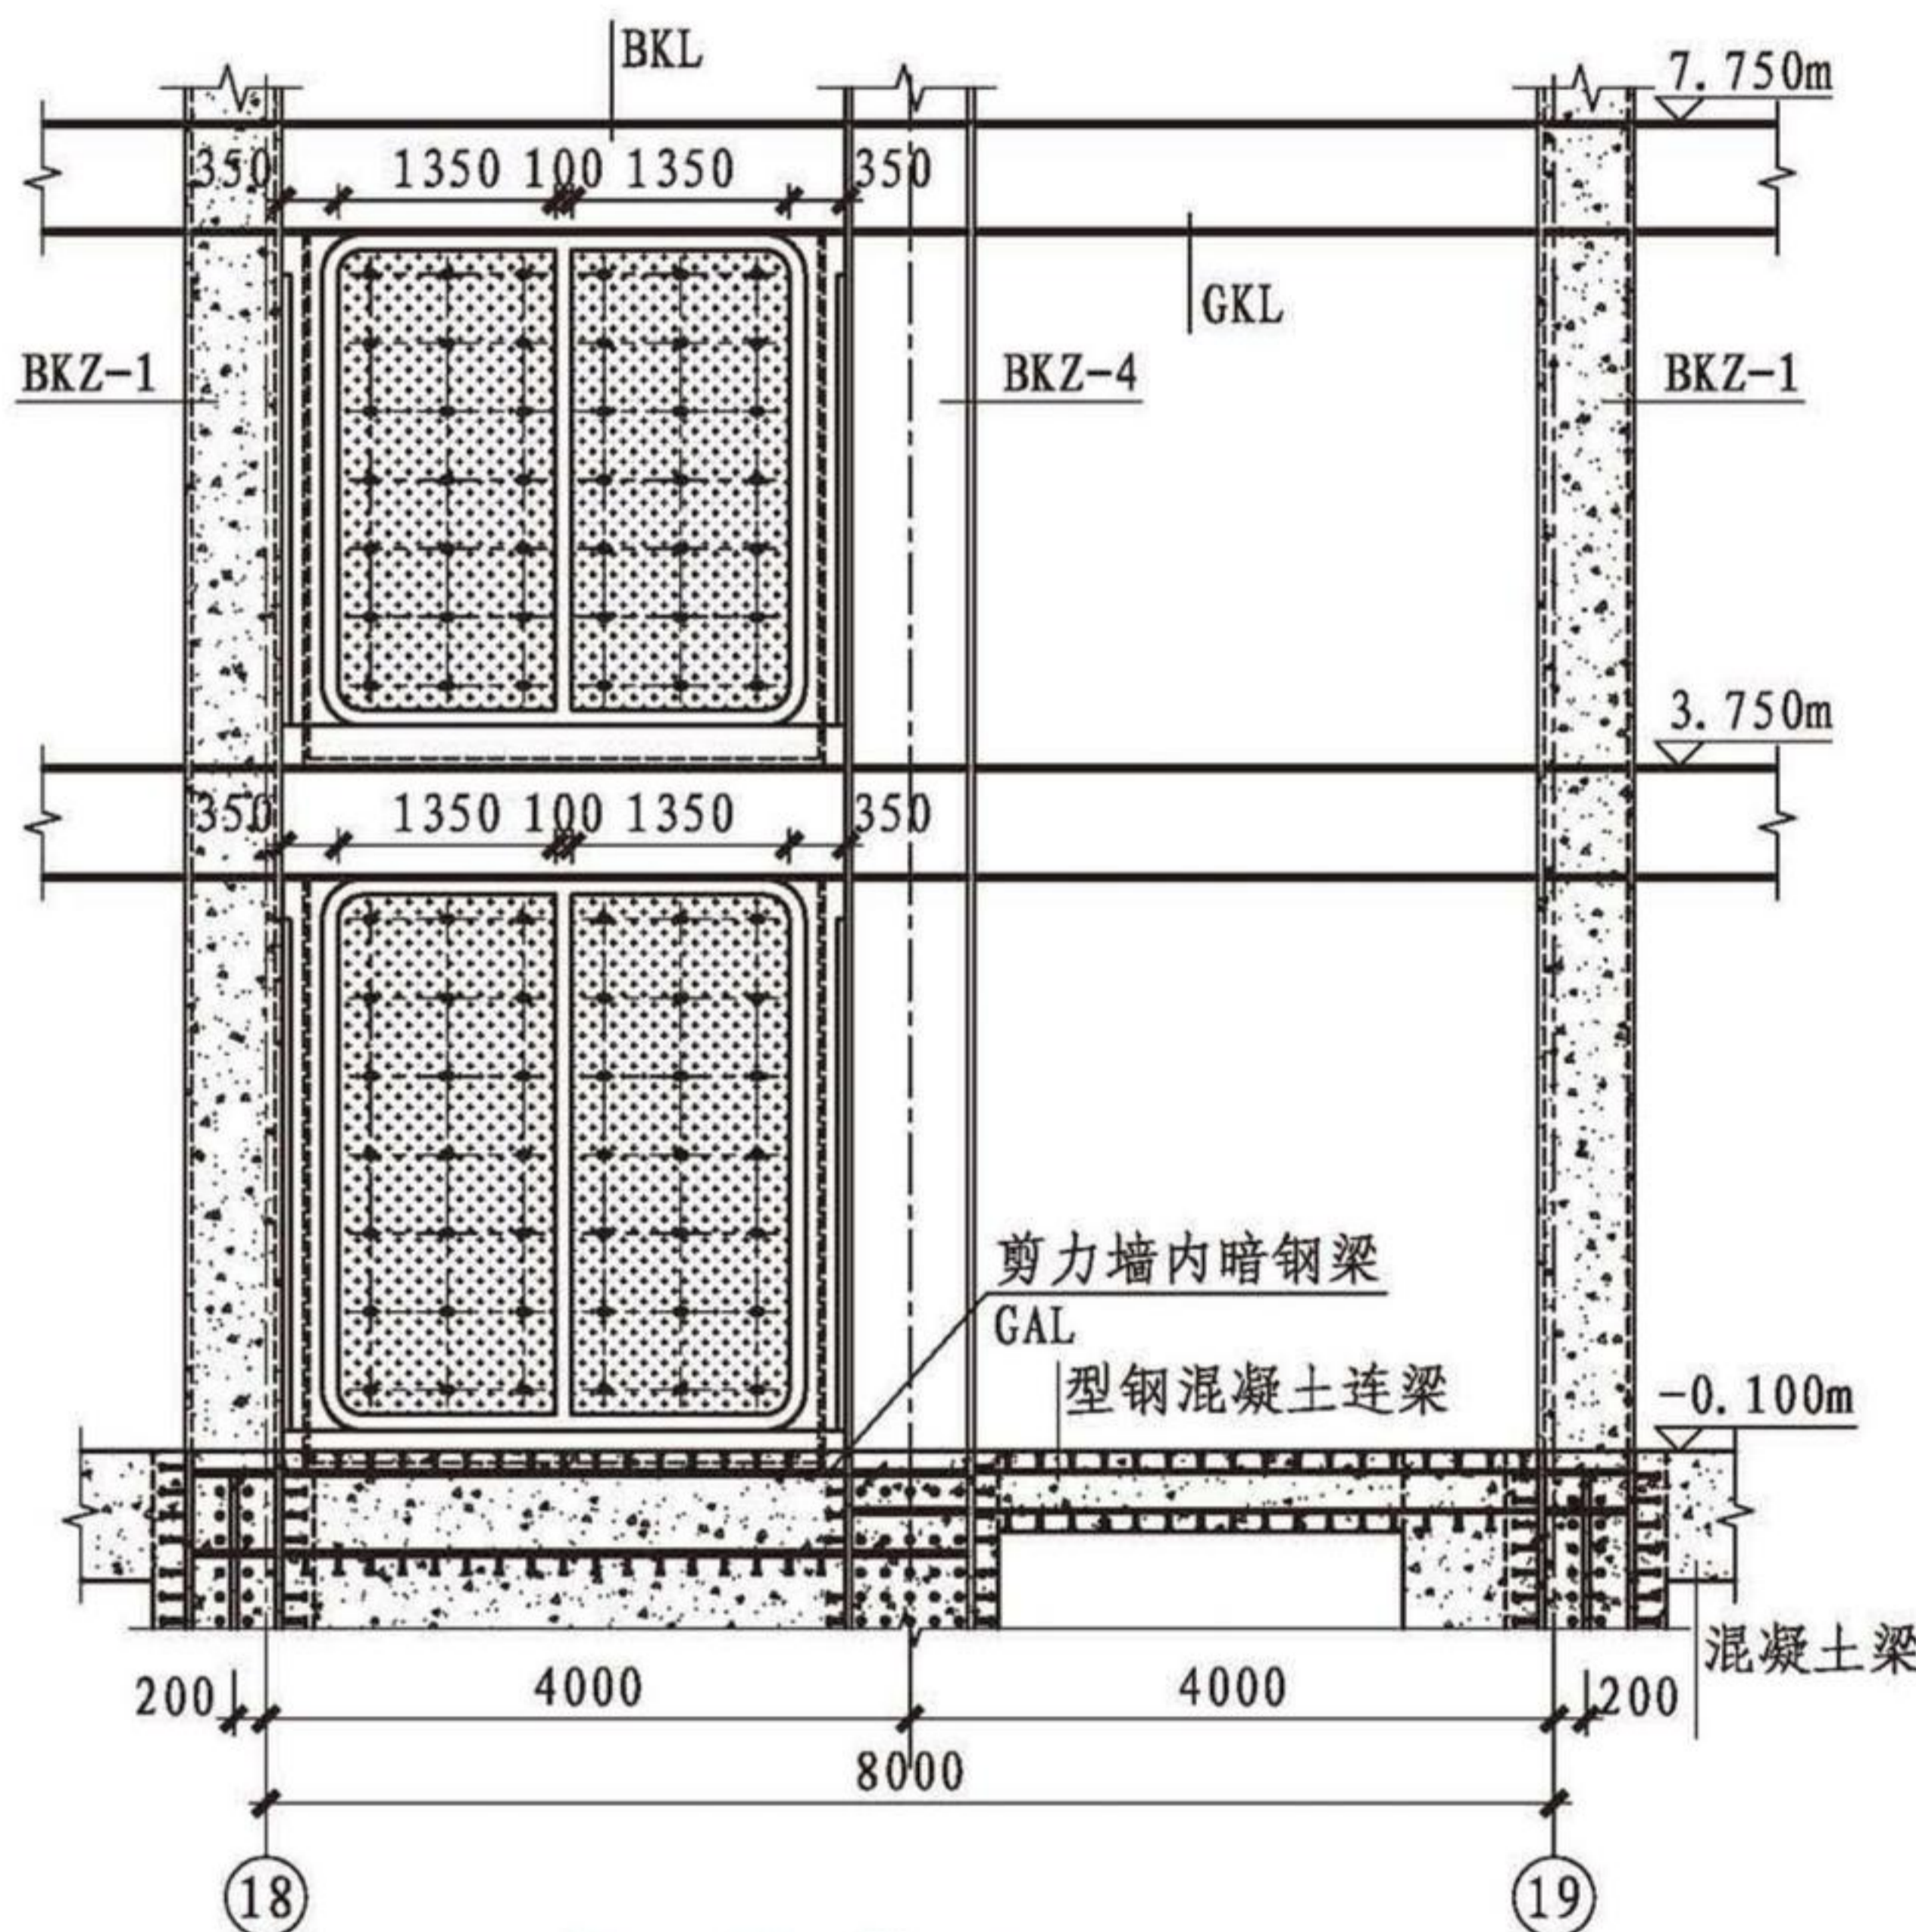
⑮ ~ ⑯ X(9)轴钢板剪力墙立面图
